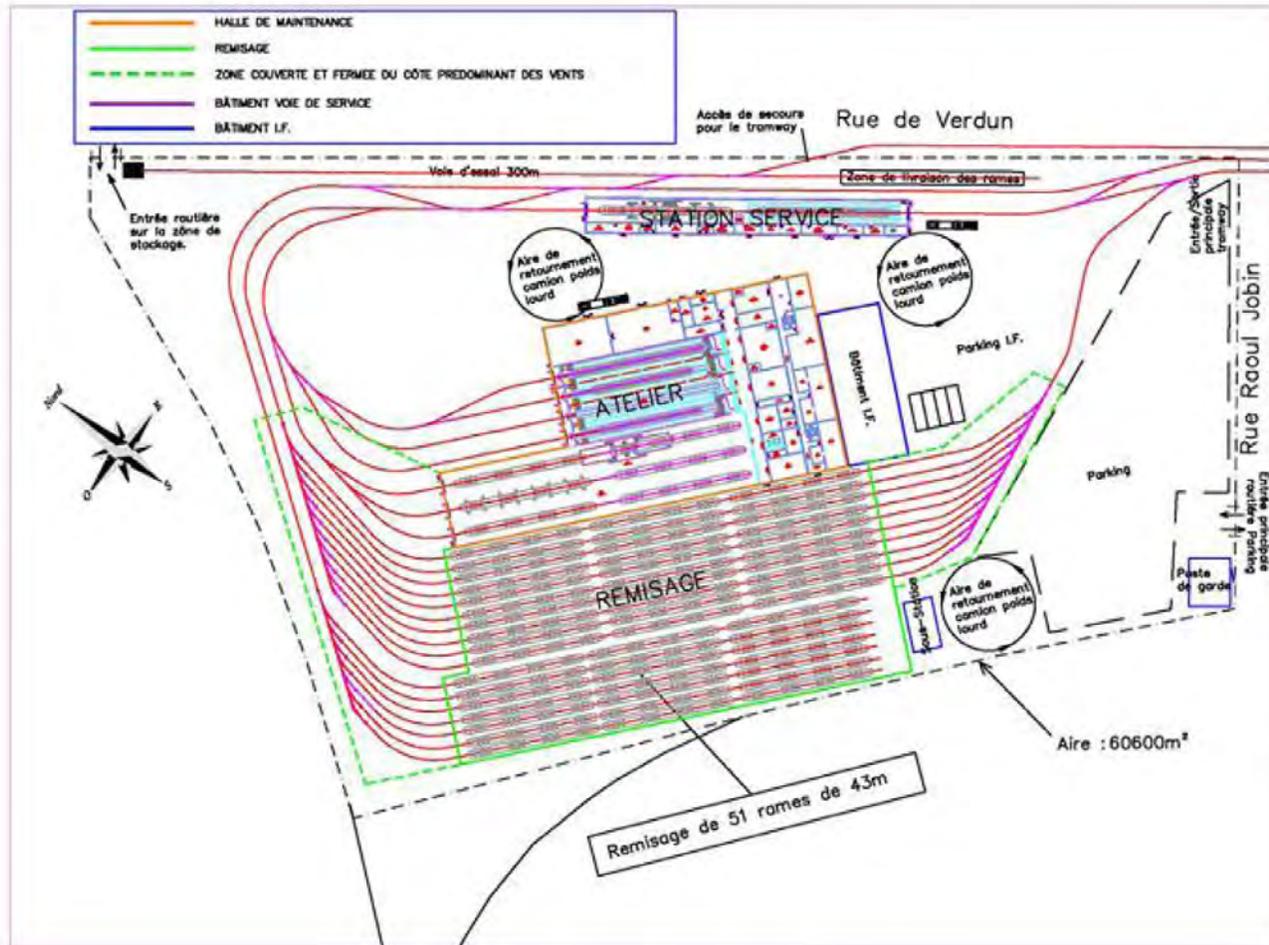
Plan masse du CEE principal rue de Verdun à Québec
